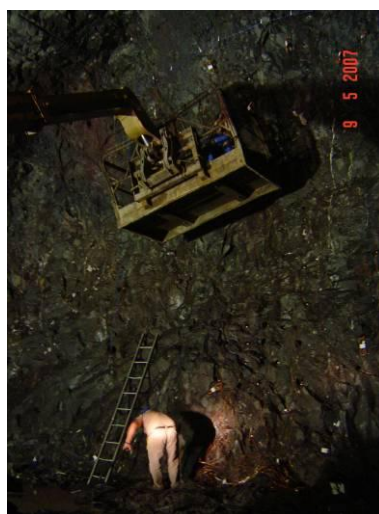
carregamento com explosivos e montagem do sistema de detonação.
